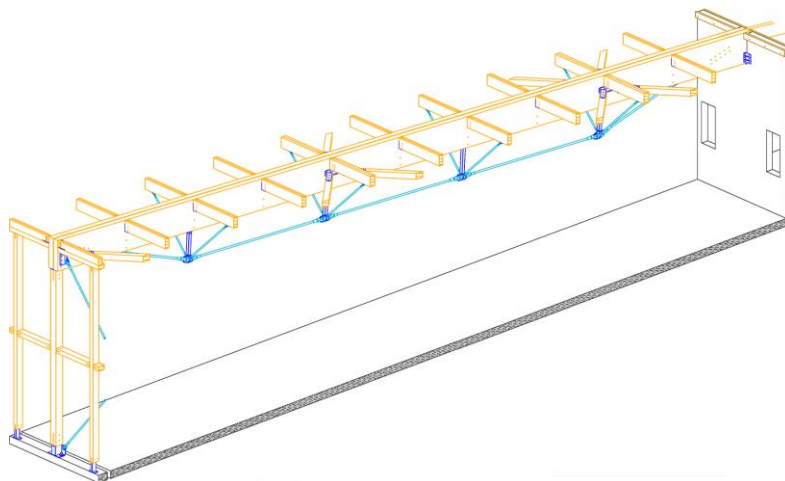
Portique étudié avec poutre sous-tendue et poteau BLC
